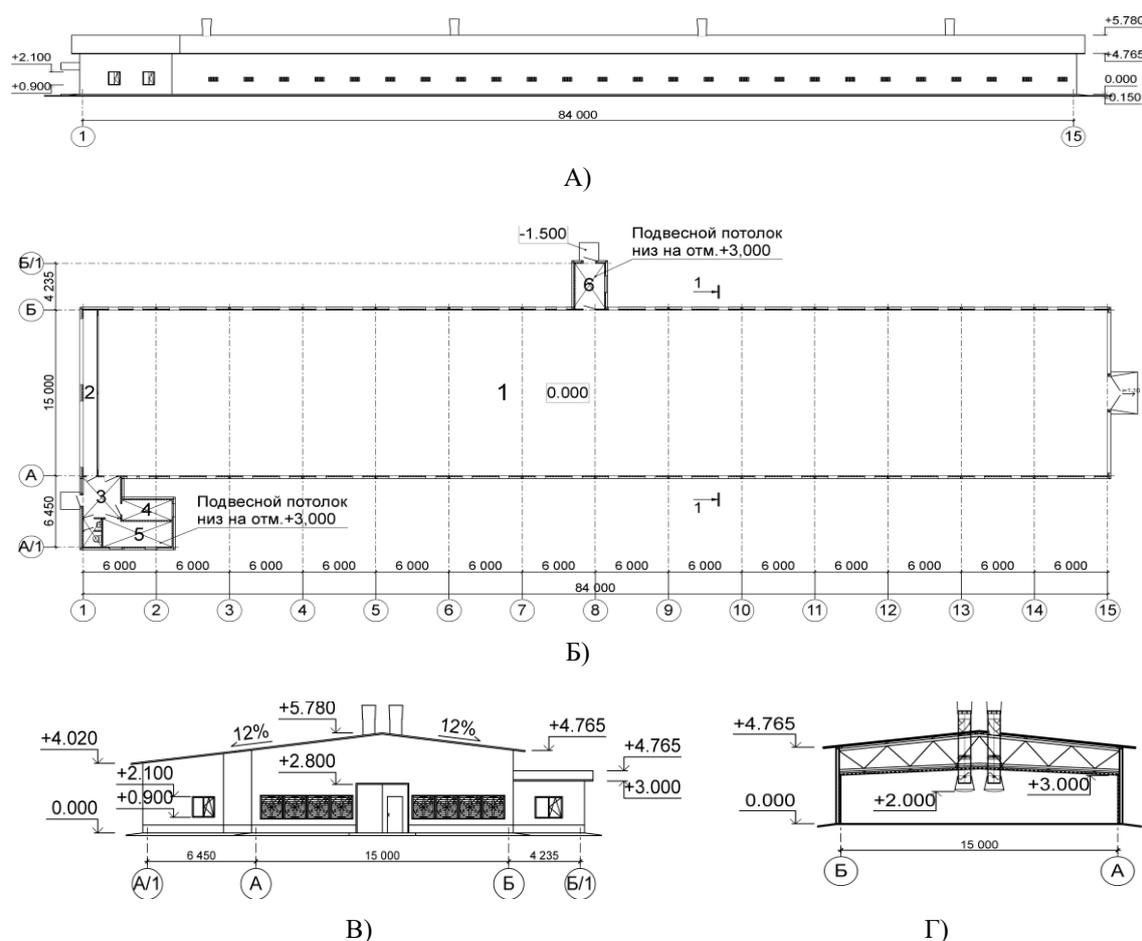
Птичник ремонтного молодняка: А) Фасад 1-15. Б) План на отм. 0,000: 1 – помещение содержание птицы; 2 – техническое помещение; 3 – тамбур; 4 – операторская; 5 – помещение водоподготовки; 6 – весовая. В) Фасад А/1-Б/1. Г) Разрез 1-1 (иллюстрация авторов).
